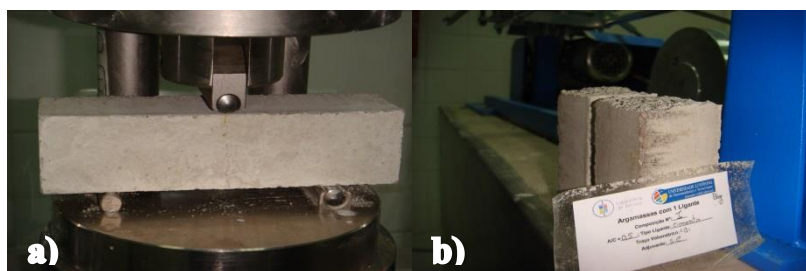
a) Ensaio de flexão; b) Provelte após rotura
